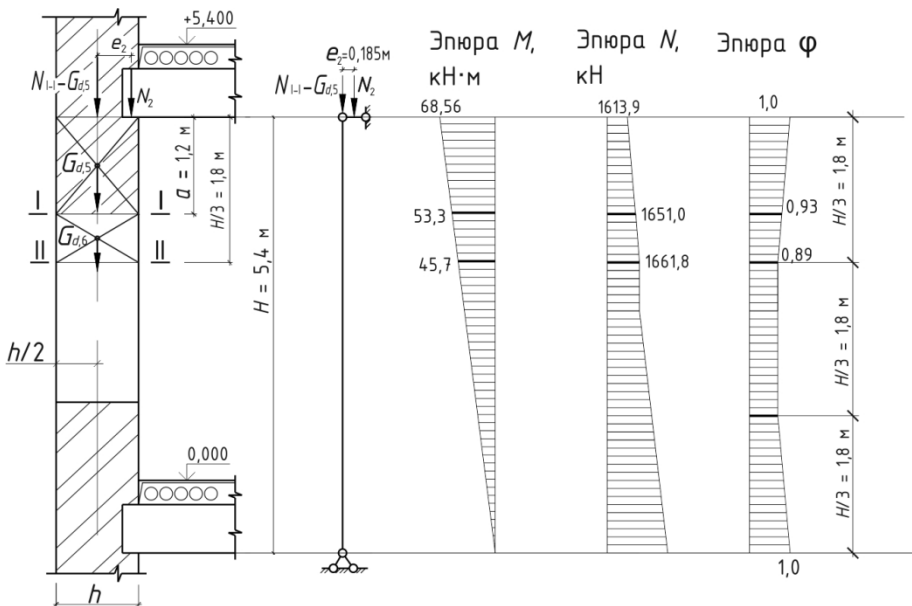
К примеру расчета простенка. Конструктивная и расчетная схемы, эпюры продольных сил, изгибающих моментов и коэффициента продольного изгиба
